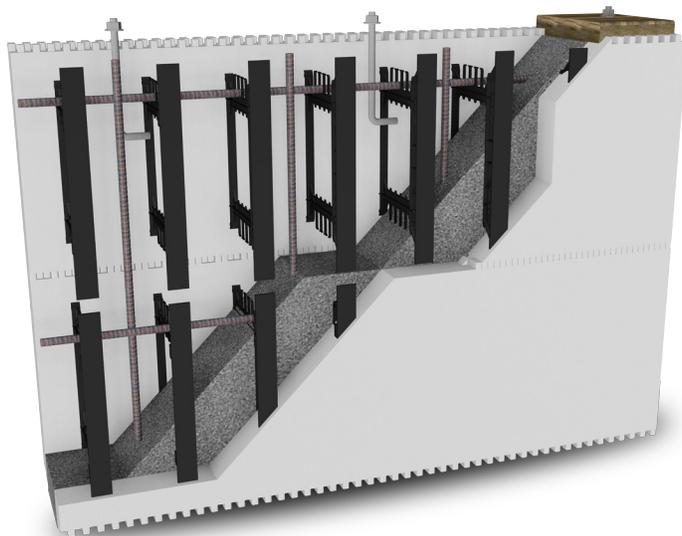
Attaches Buildblock, placement des barres d'armature et béton.
